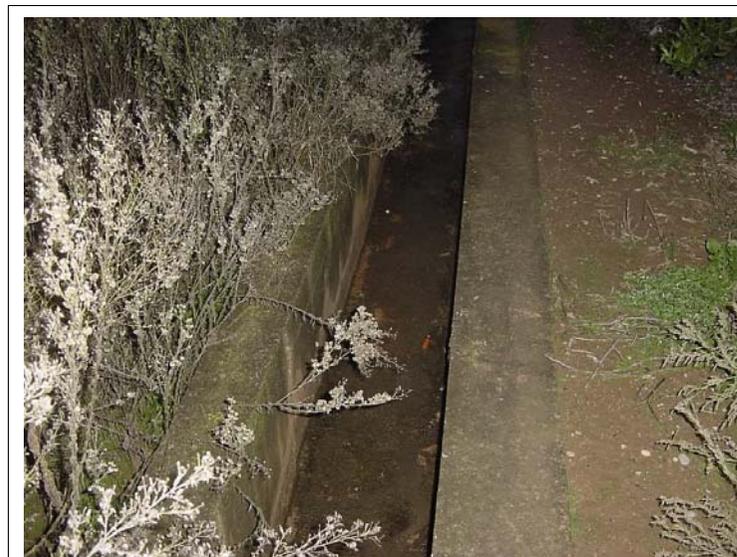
Acequia de 50x60 con muros de 20 y 30 cm de ancho.
